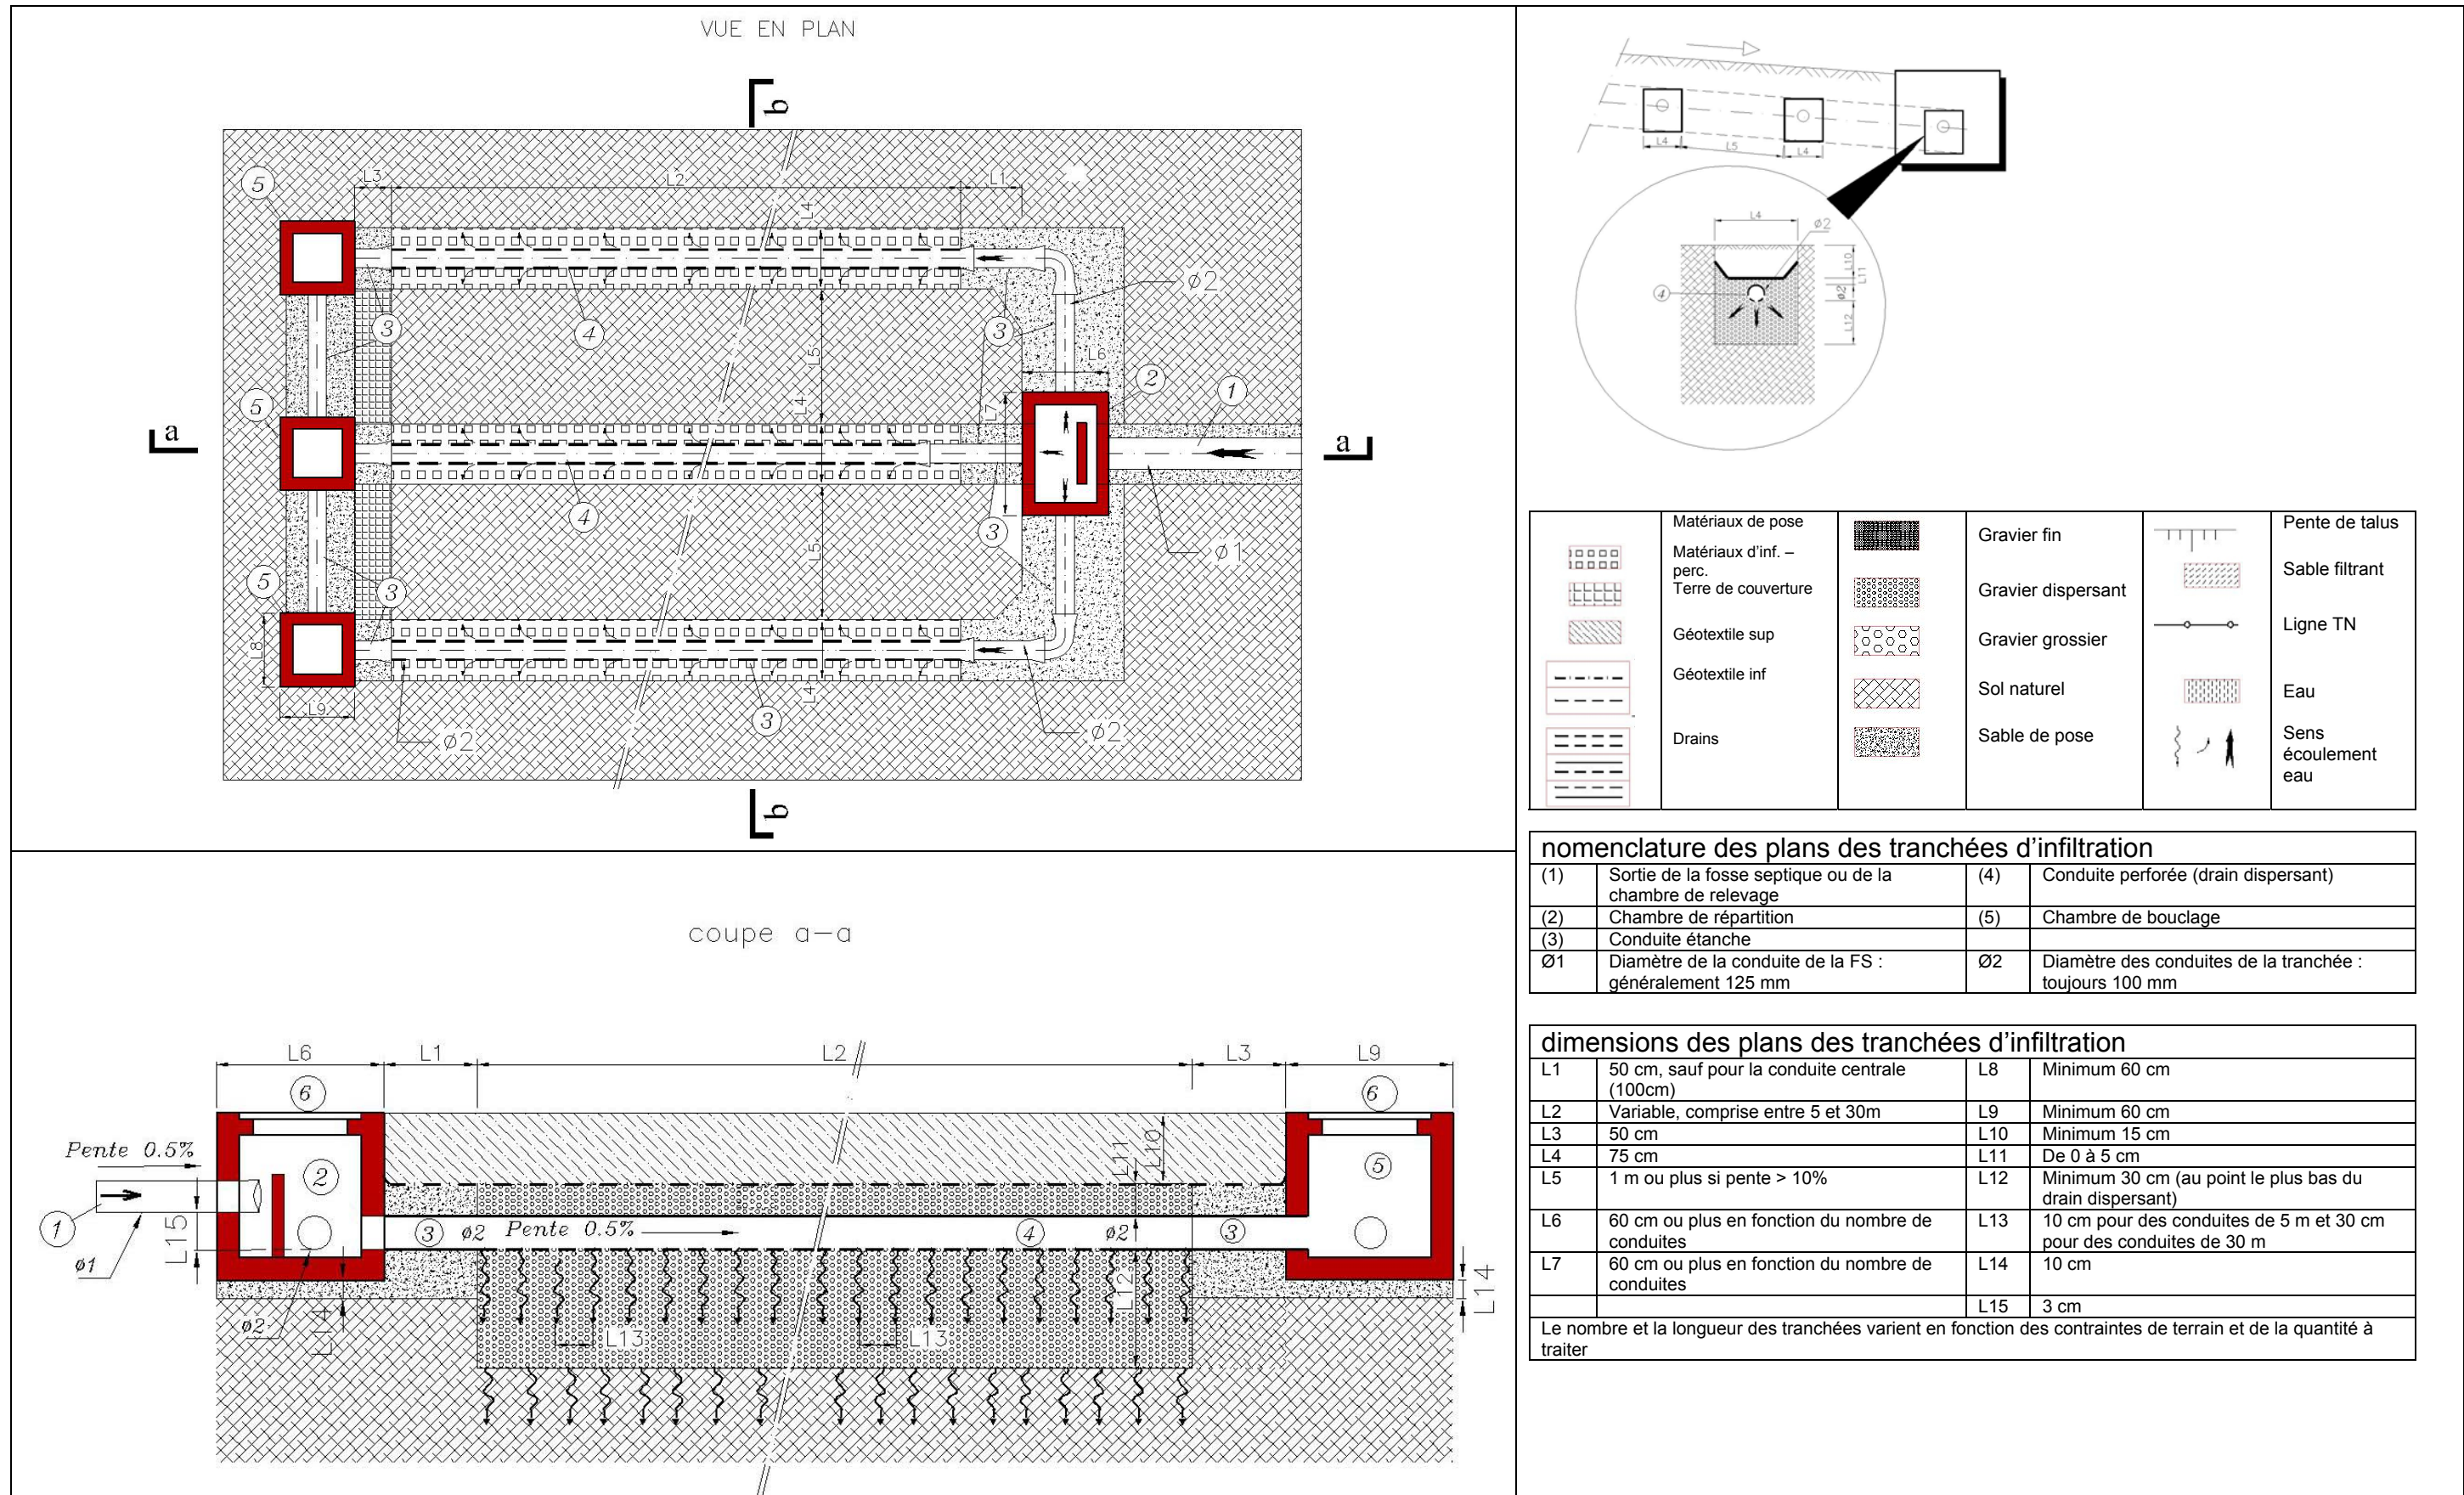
Vue en plan et coupes de tranchées d'infiltration
